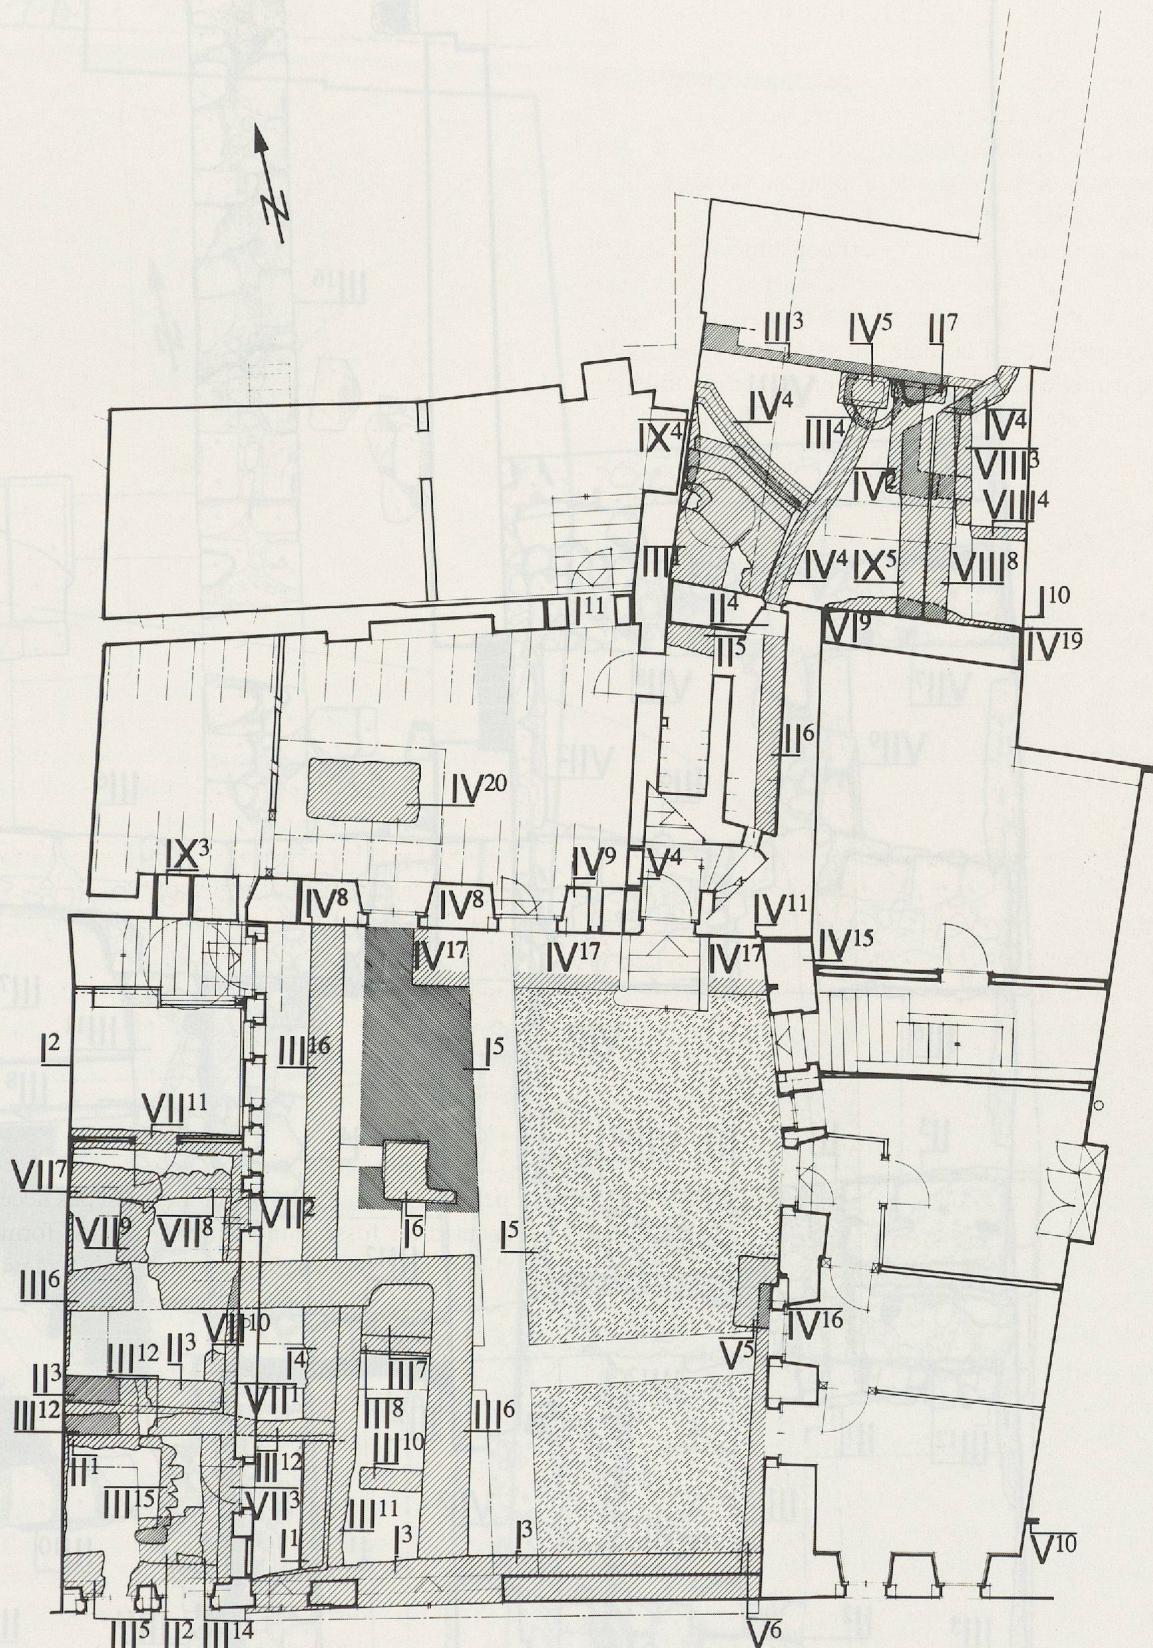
Plan du rez-de-chaussée (éch. 1:150).
